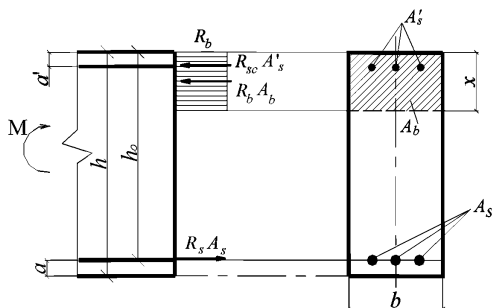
Схема усилий и эпюра напряжений в поперечном прямоугольном сечении изгибаемого железобетонного элемента
